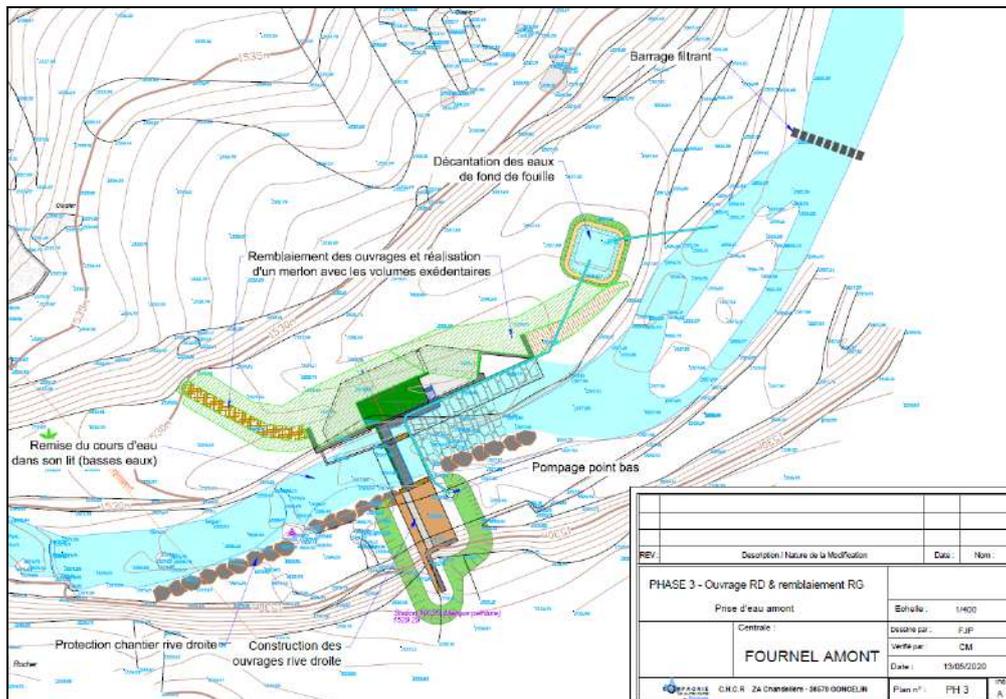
Phasage des travaux au niveau de la PE amont – Construction des ouvrages rive droite
